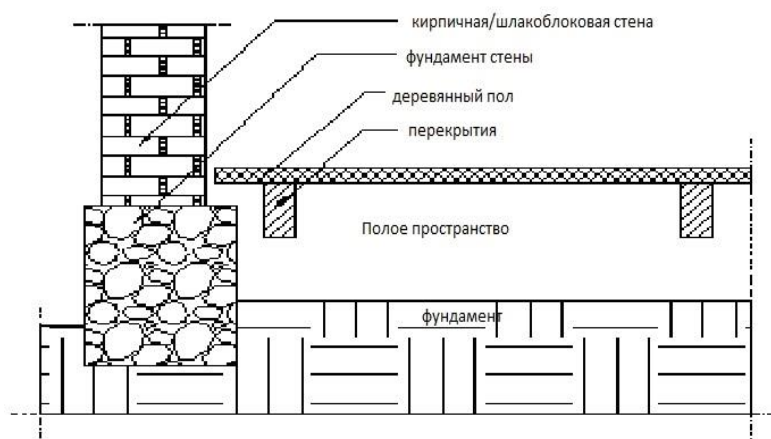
Конструкция фундамента здания с подпольным пространством
